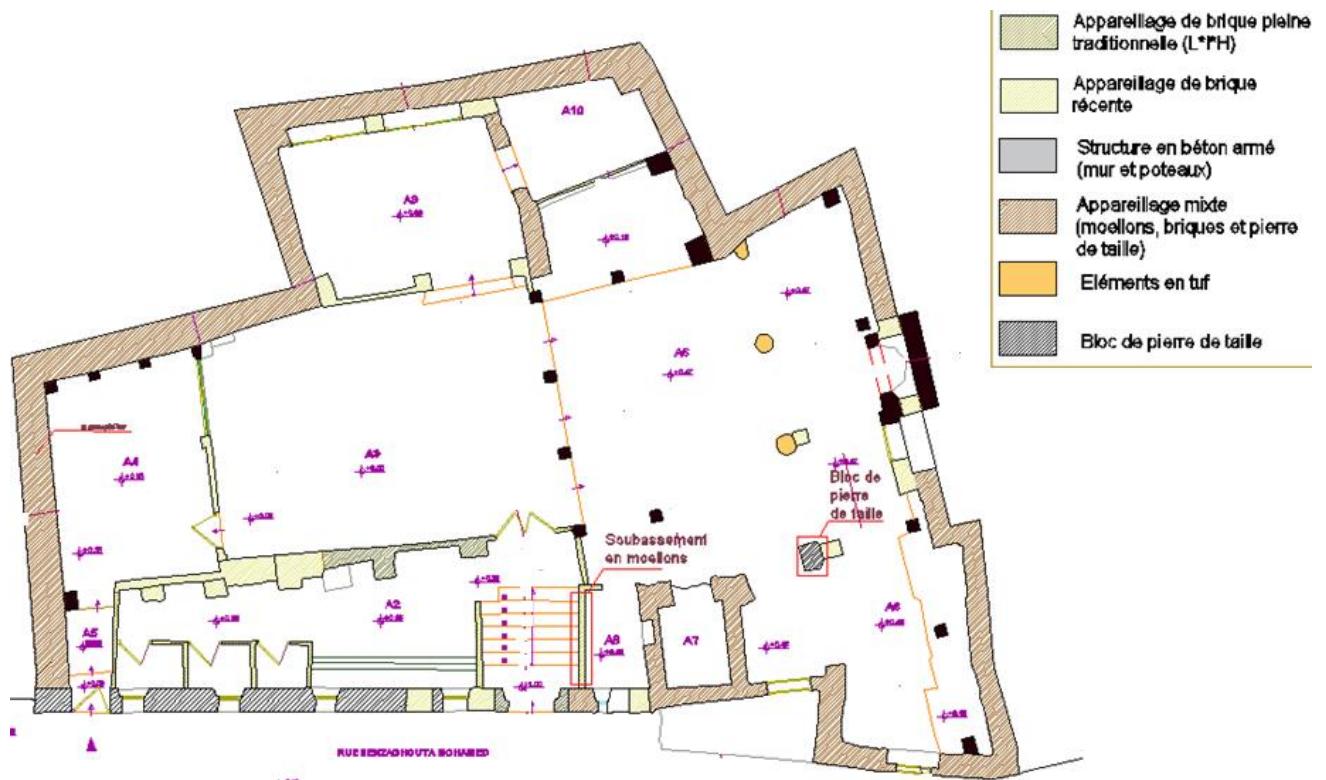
Système constructif de la mosquée Sidi Affane. Source: Fond Groupement ZIANI- Mahidad traité par l'auteure.
